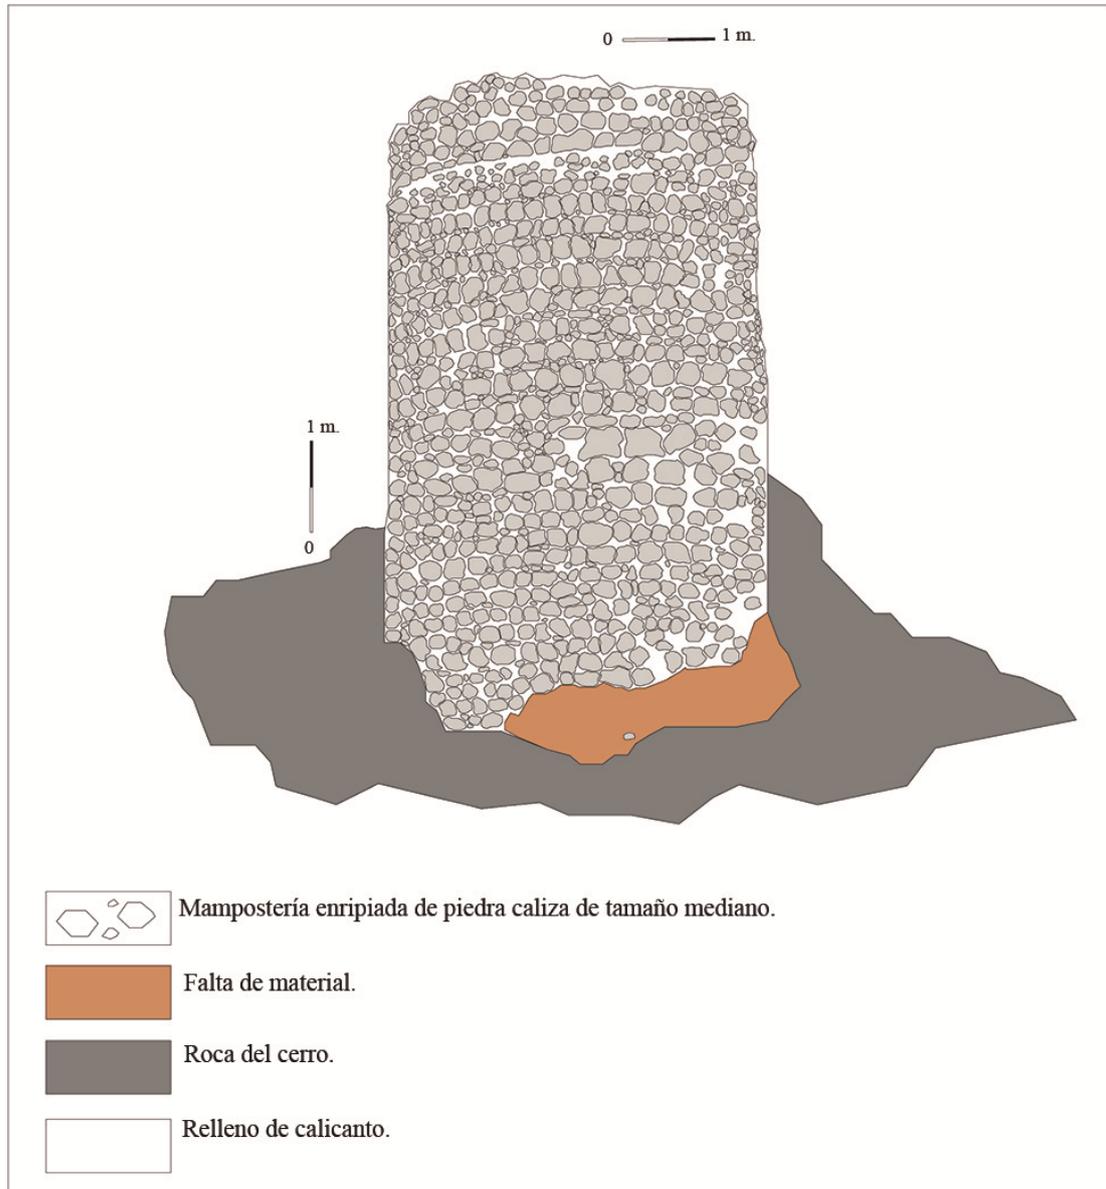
La torre (T_18) en su cara sureste. La técnica constructiva, mampostería enripiada de piedra caliza de tamaño mediano. (Elaboración propia).
